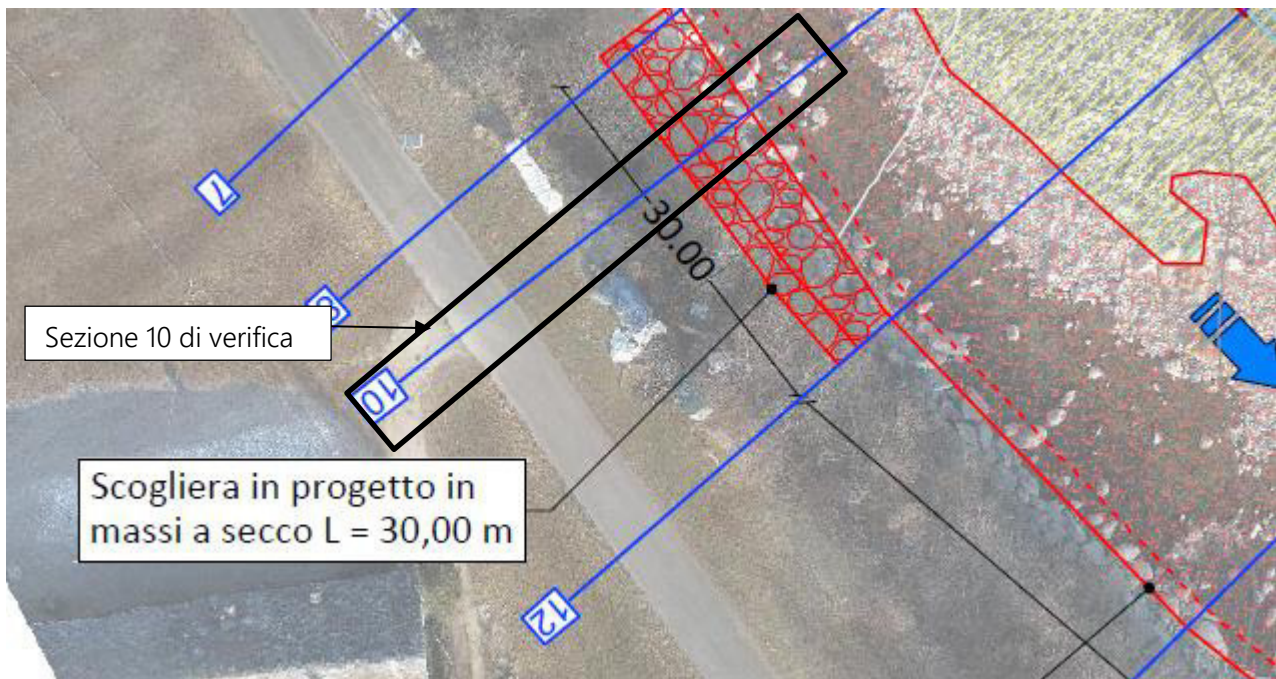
Tav. 03.3_ Planimetria di progetto – Sezione di verifica
